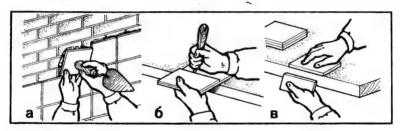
Основные операции по облицовке плитками. в — укладка плитки с раствором; 6 — разрезание плитки; в — разламывание плитки
